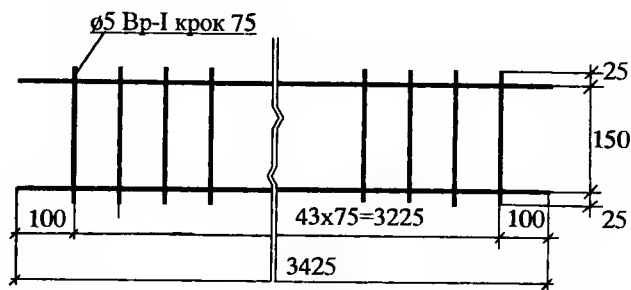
Креслення плоского арматурного каркаса КР-19
